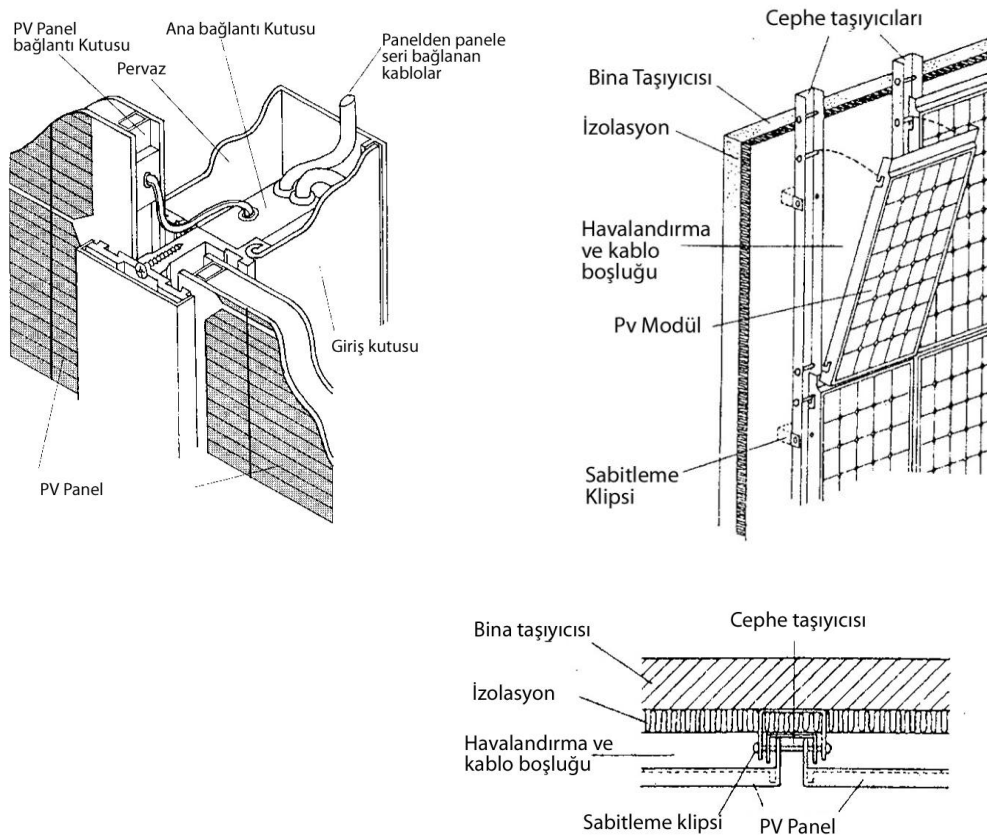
Yapılarda kullanılan PV kollektör detayı [98]
